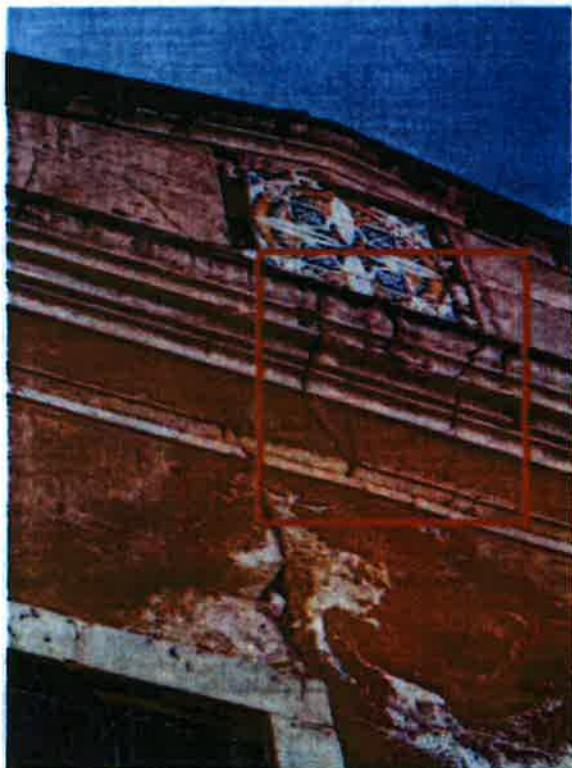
e 2- Fachada frontal e fachada lateral
